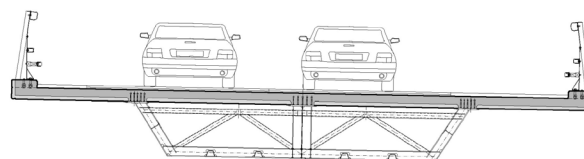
Sección tipo de las estructuras E-10, E-11 y E-12
